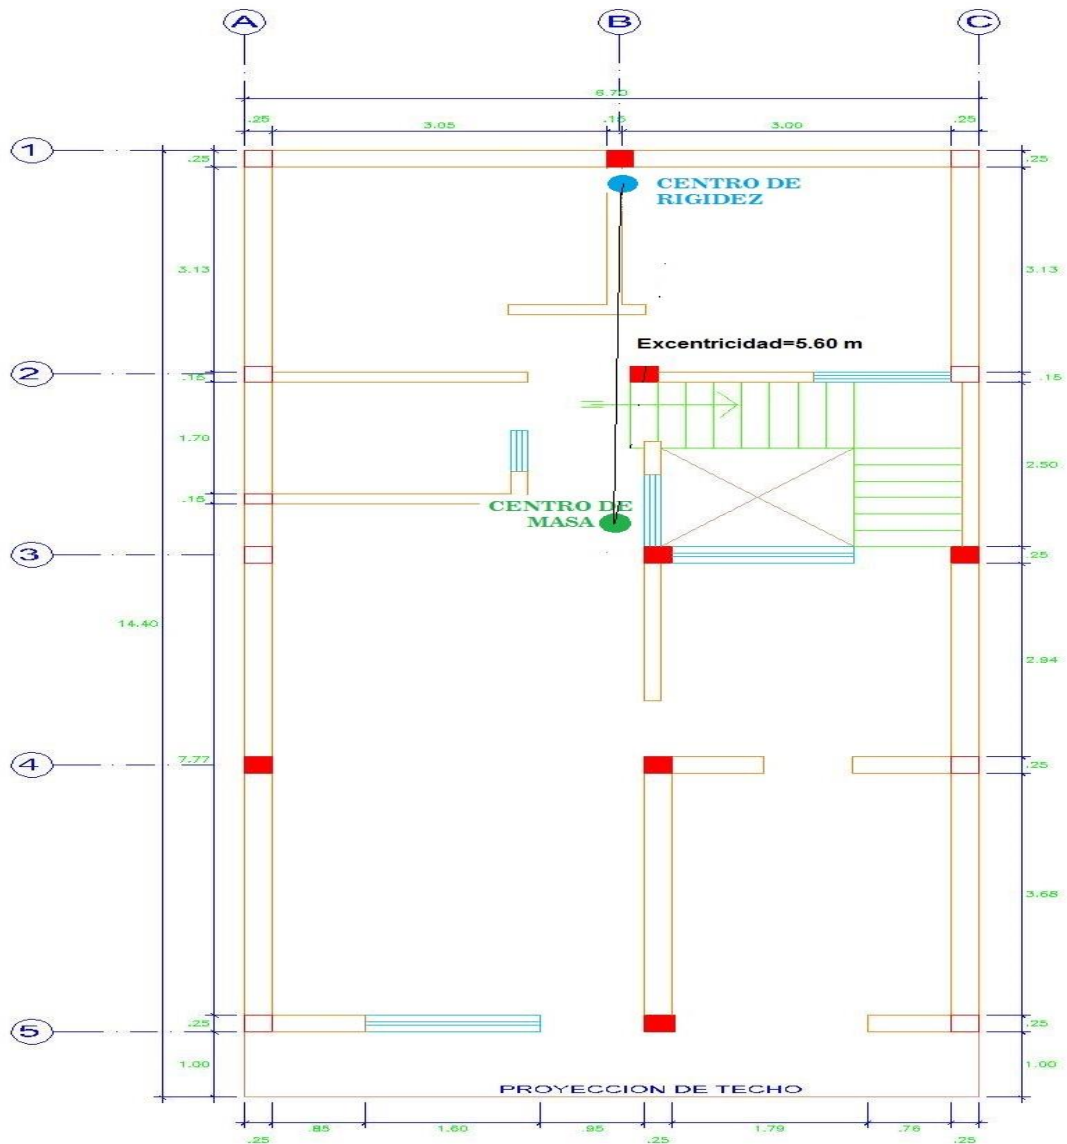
Ubicación del centro de masa y centro de rigidez en el plano de vista en planta del primer piso - Lote 64 (Fuente: Elaboración propia)
